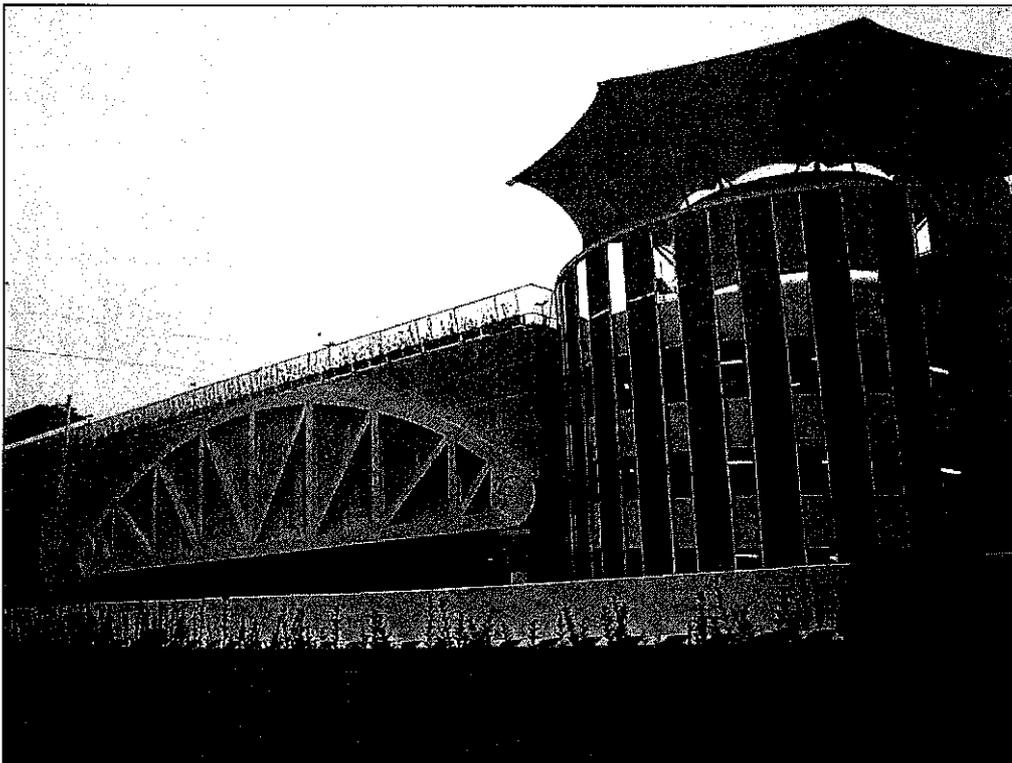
FOTO ESTERNA DELL'EDIFICIO – RAMPA E TRAVE “ZONA PONTE”
